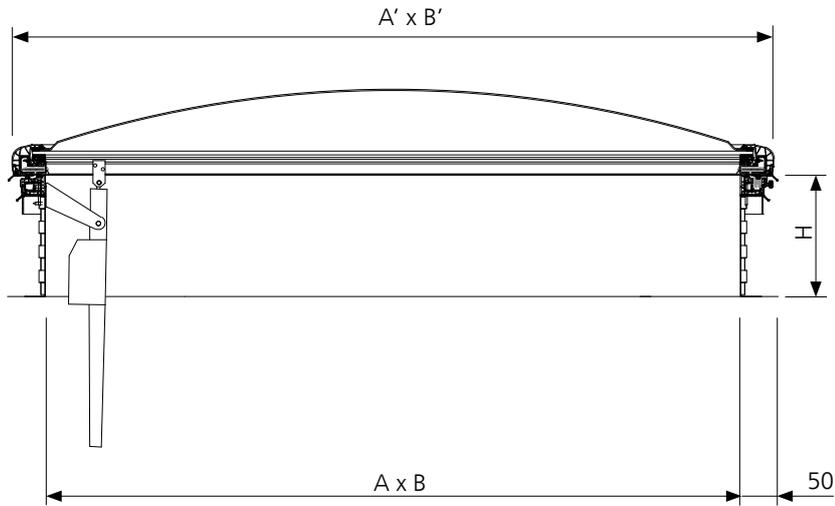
Schnitt B-B durch eine Lüftungsklappe mcr ULTRA THERM Typ E in geschlossener Stellung, Maße in [mm]
